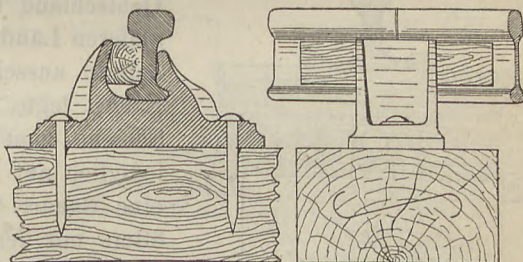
Stuhlschiene auf Holzquerschwellen.
